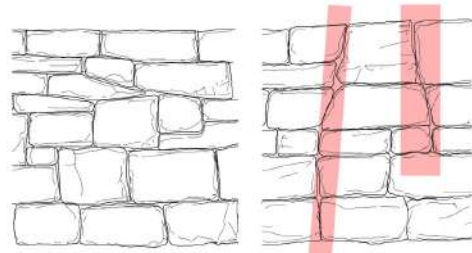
Inserimento di pietre proporzionalmente più piccole fra quelle già posate
